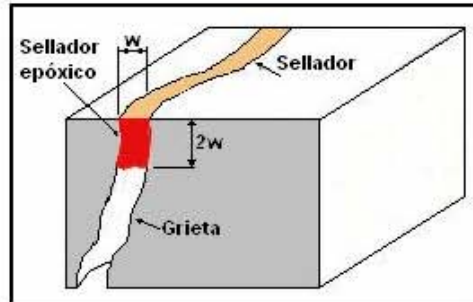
Se debe considerar una profundidad de sellado de 2 veces el ancho de la grieta (Trout, 2005)
